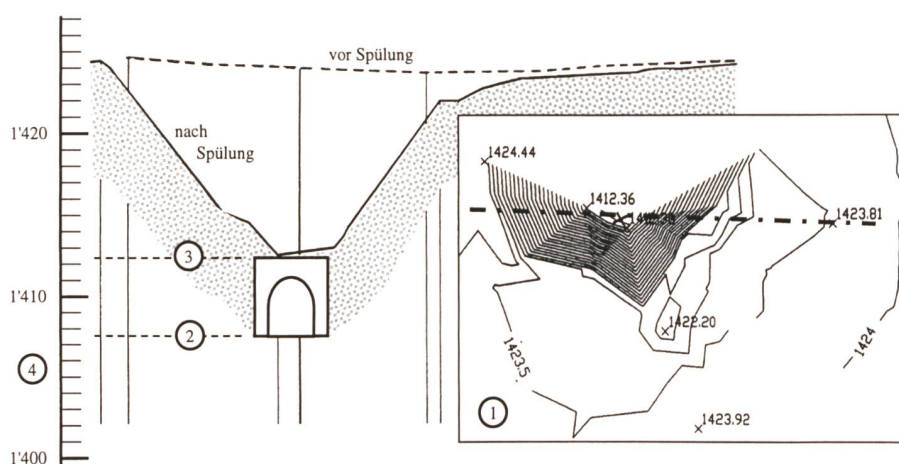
Einlauftrichter in den Seesedimenten beim Grundablass, durch Echolotmessungen vor und nach der Spülung vom 4. Juni 1992 bestimmt. ① Grundriss mit Höhenkurven 0,5 m mit Profilachse, ② Einlaufschwelle des Grundablasses, ③ Oberkante des Grundablasses, ④ Vertikaler Massstab in m ü. M.
